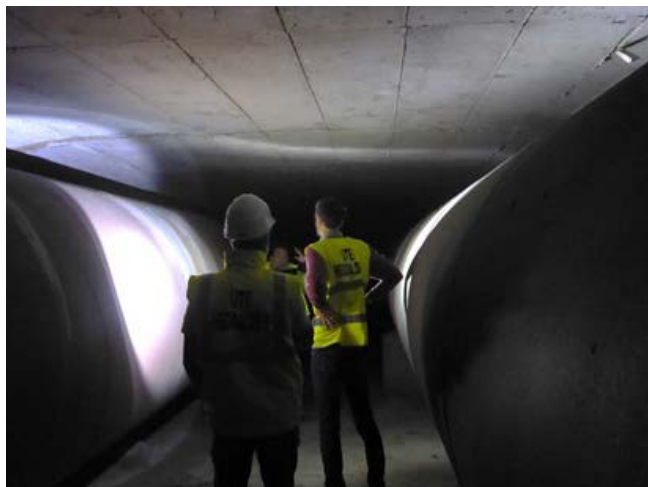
Interior de la sección cajón del acueducto y tuberías de 1800 mm de diámetro.
